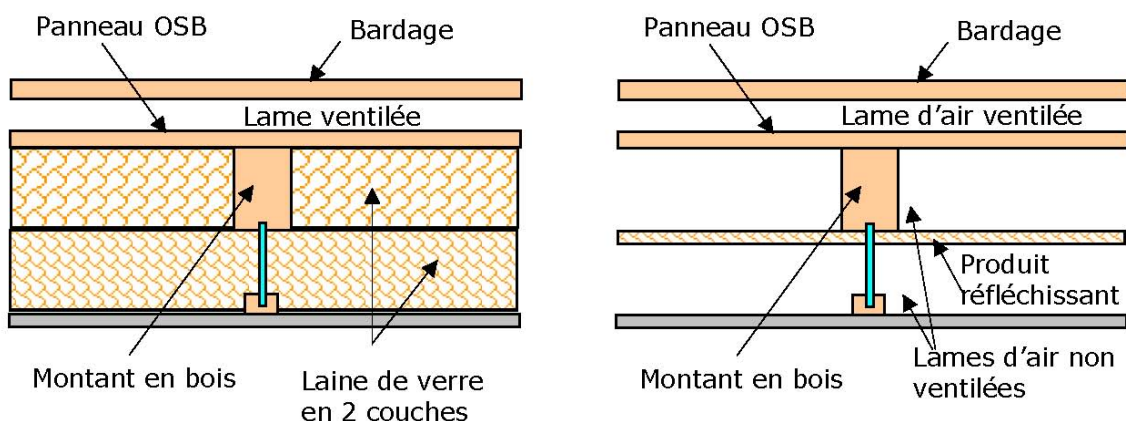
coupes schématiques dans un mur (même principe en toiture)
